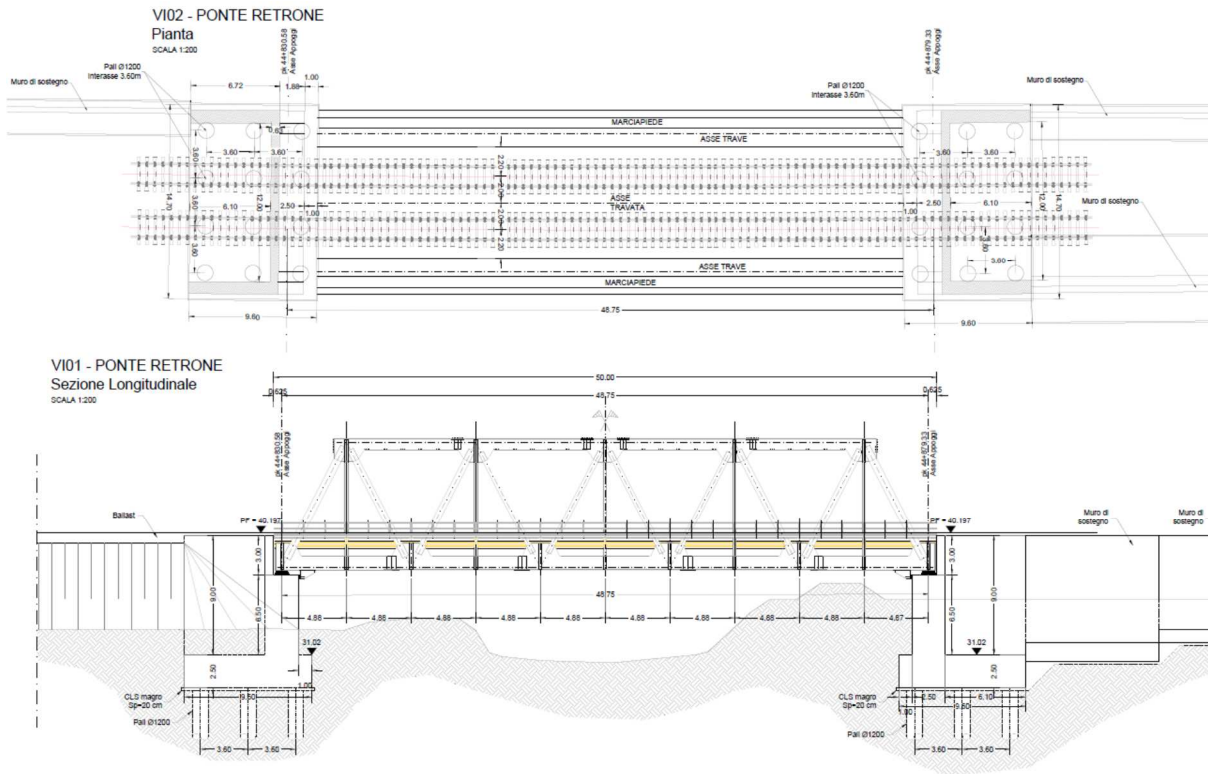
Planimetria e Profilo del Ponte Retrone
